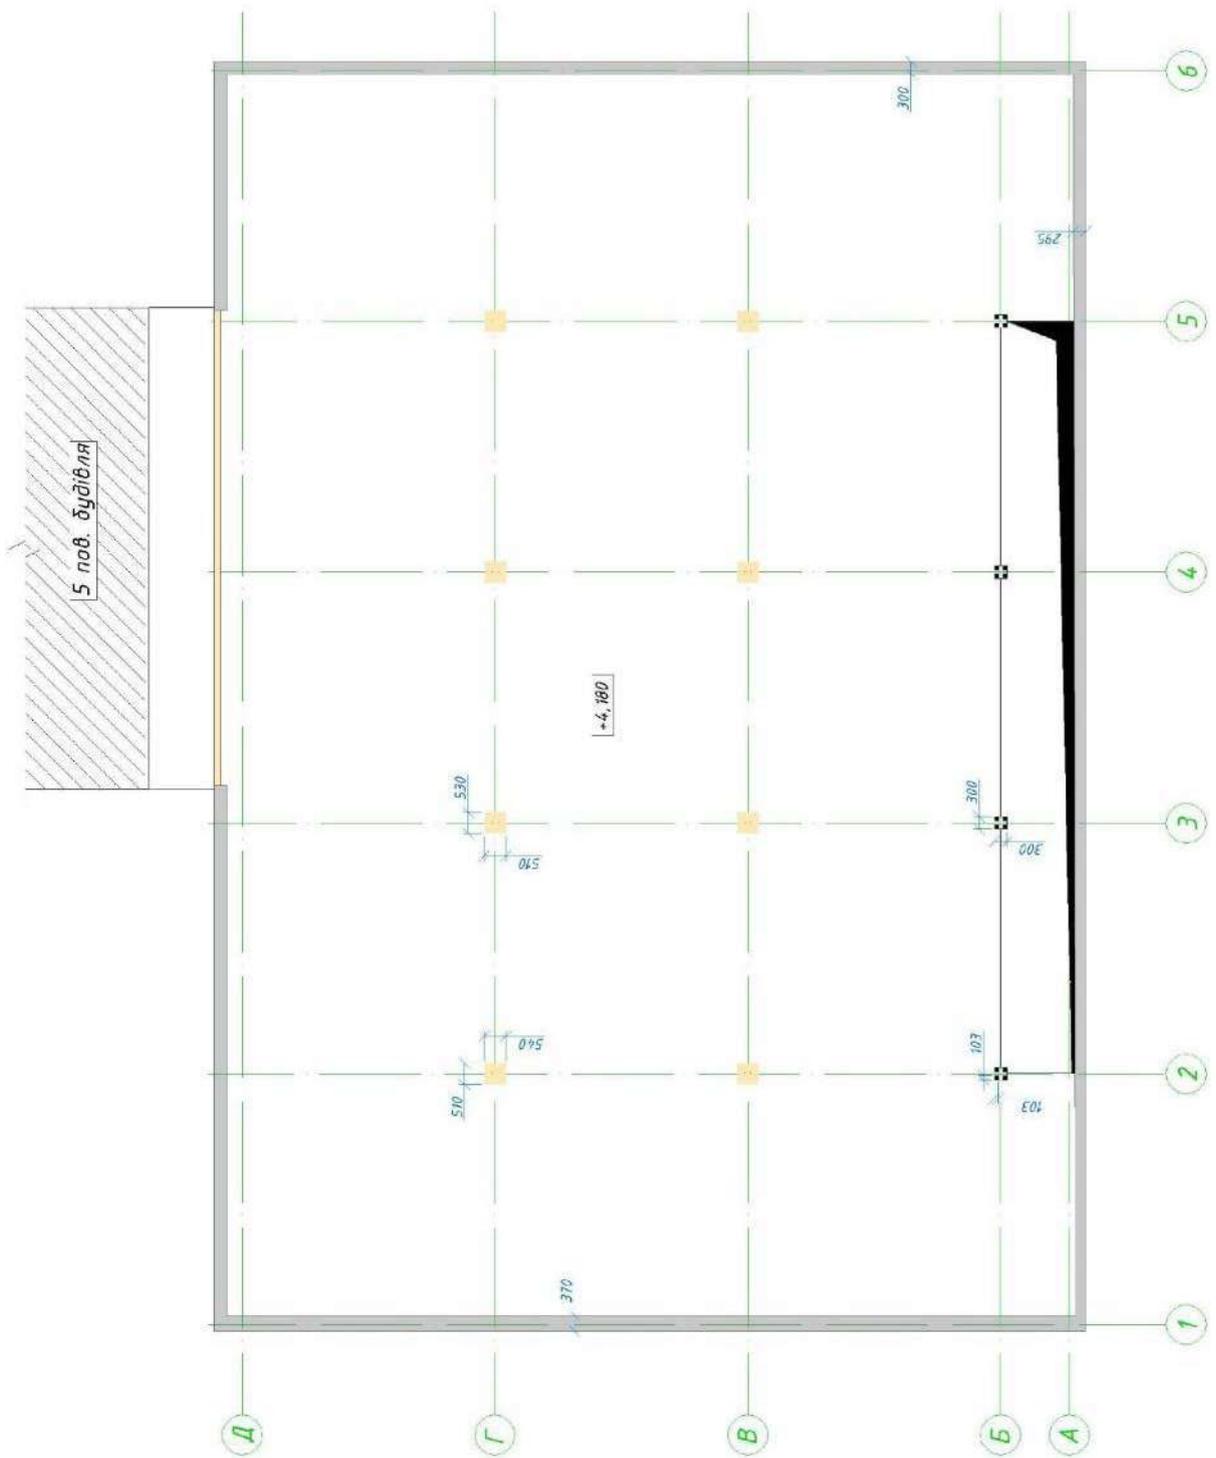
Схематичний план 2-ого поверху будівлі обстеження
